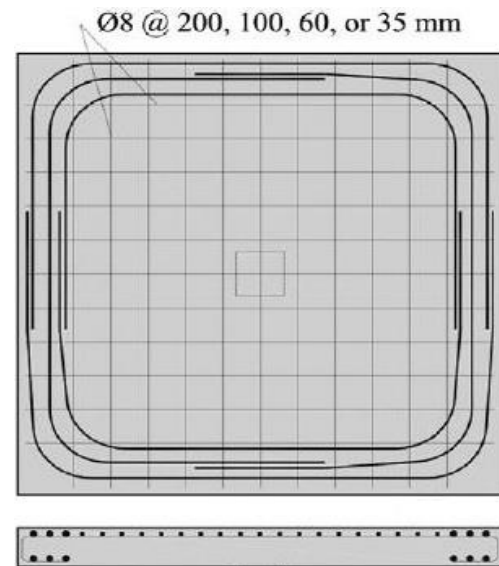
Esquema da disposição de armaduras das lajes do 1º grupo de ensaios
